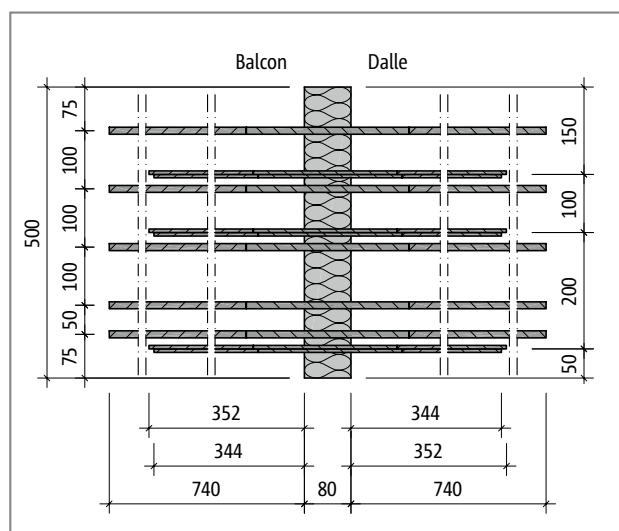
Schöck Isokorb® T Type D-MM4-VV1 en longueur L500 : Plan de base
